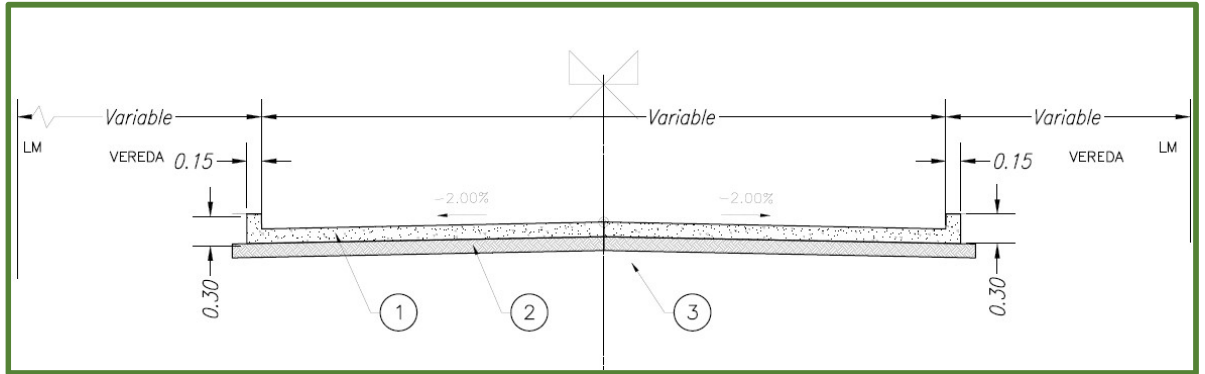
Perfil Tipo Pavimento Rígido para Calles (Municipalidad de Córdoba)
